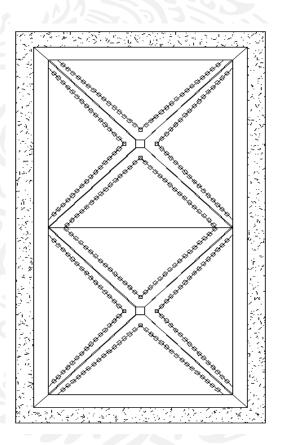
Arreglo tipo de flotadores para cubierta flotante en hoyas.
